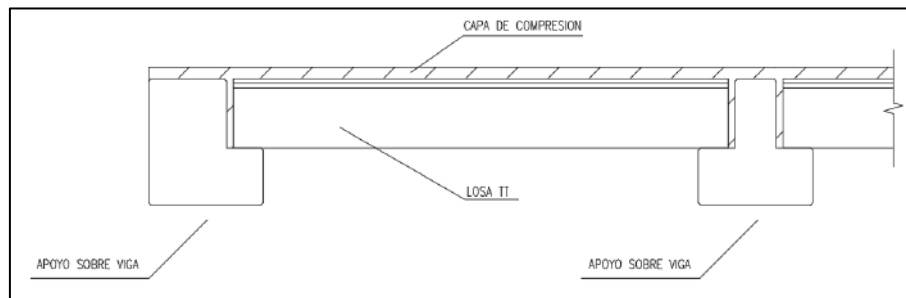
Esquema de losa apoyada en vigas pretensadas.
